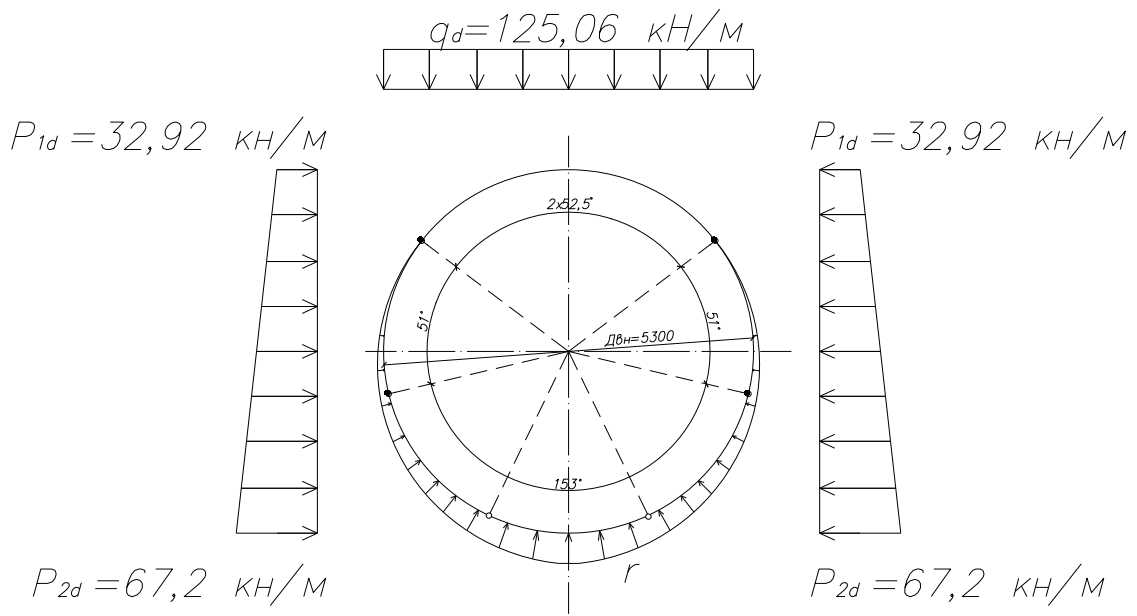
Схема нагрузок на железобетонную блочную обделку
